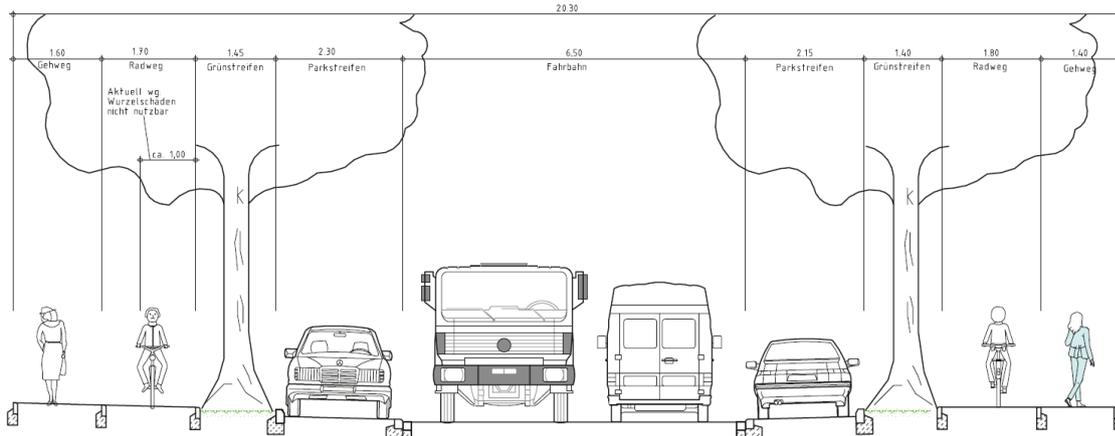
Straßenquerschnitt zwischen Berliner Straße und Franz-Marc-Straße – Blickrichtung Berliner Straße
